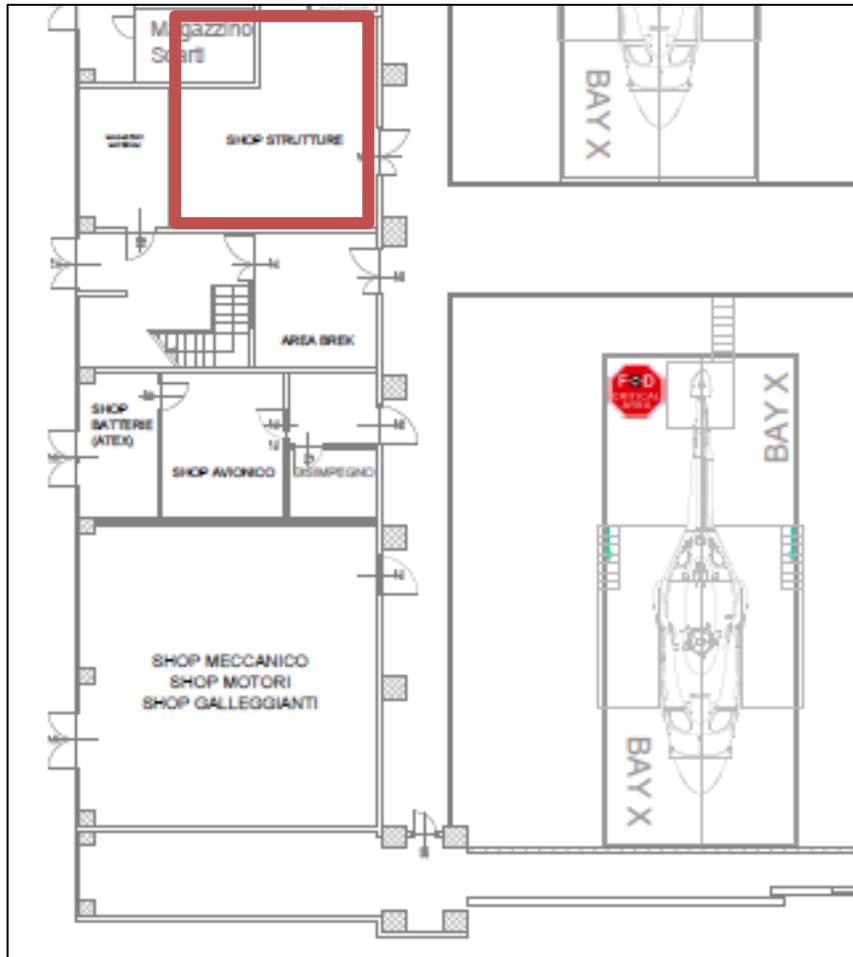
Planimetria del fabbricato 24 - evidenziato in rosso lo shop strutture
